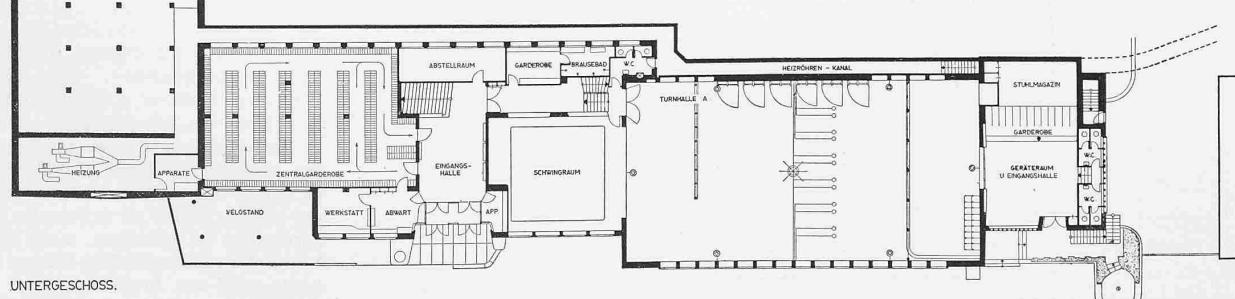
Untergeschoss-Grundriss, rd. 1:600
